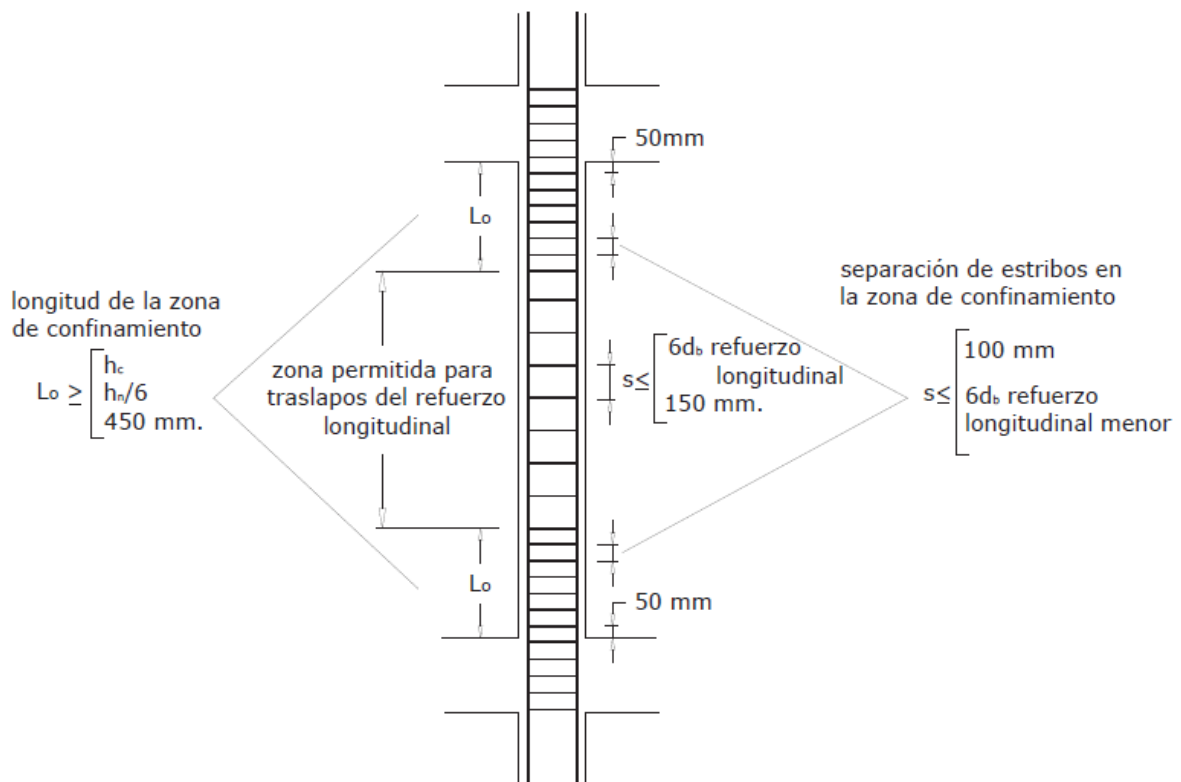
Disposición del confinamiento para columnas según la NEC-SE-HM (Hormigón Armado)
